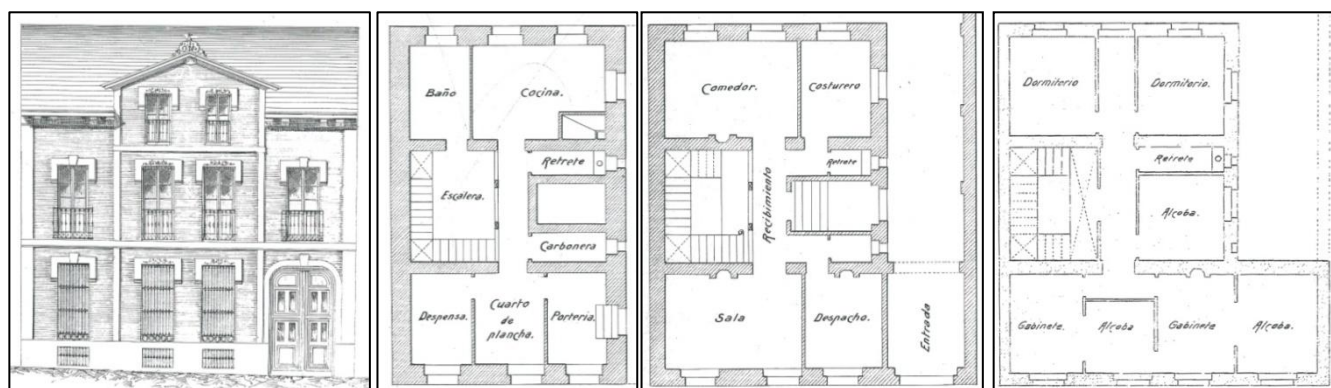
Planos de la fachada, sótano, bajo y principal del hotel de José Verdú, situado en el nº 84 de la calle Lagasca en 1904. AVM, Secretaría, signatura 14-441-29.
